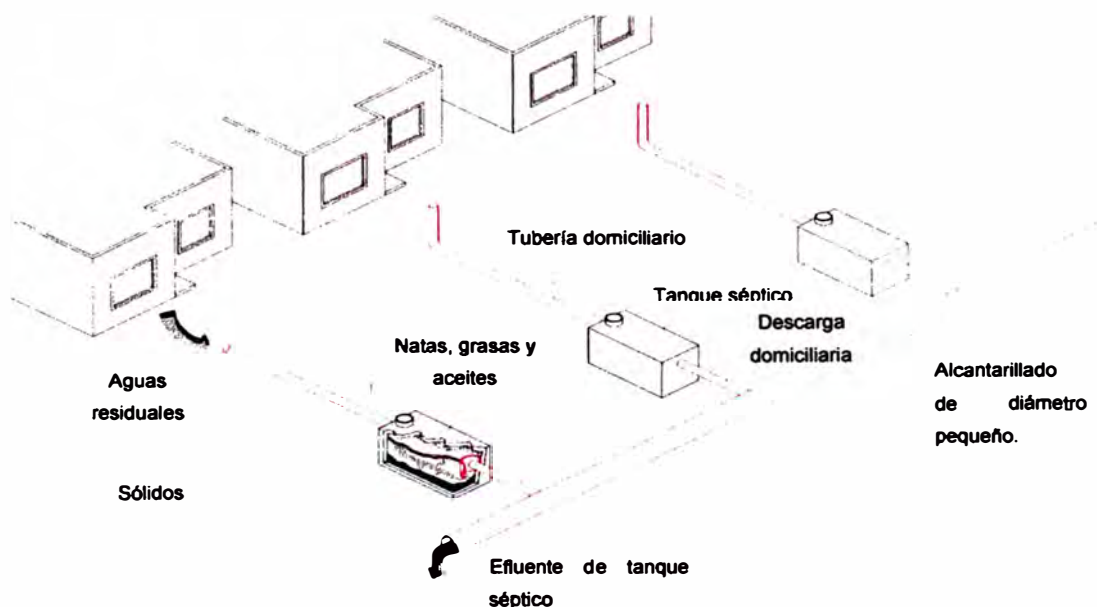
Alcantarillado de diámetro pequeño
